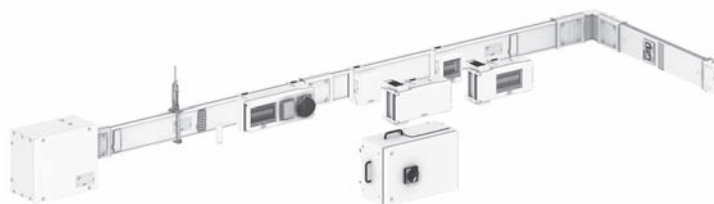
Жесткий шинопровод, рассчитанный на крепление осветительной арматуры: Canalis KVA или KVB (25 и 40 A)
